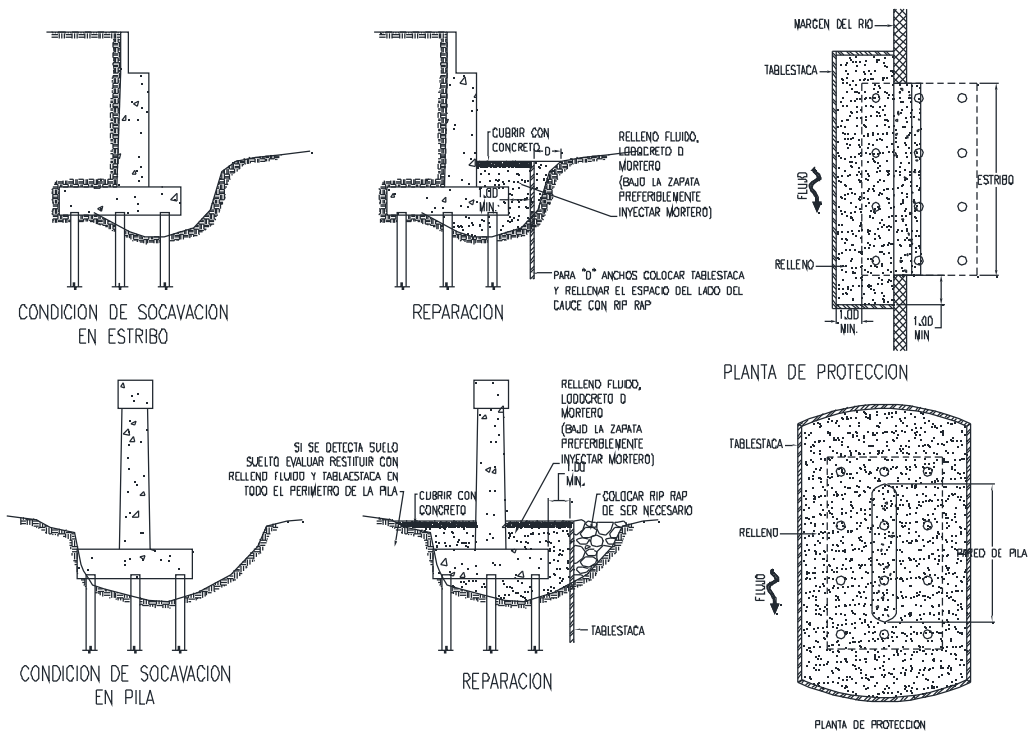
Propuesta de reparación en pilas y estribos de fundación con pilotes. (SPOP, 2014)
